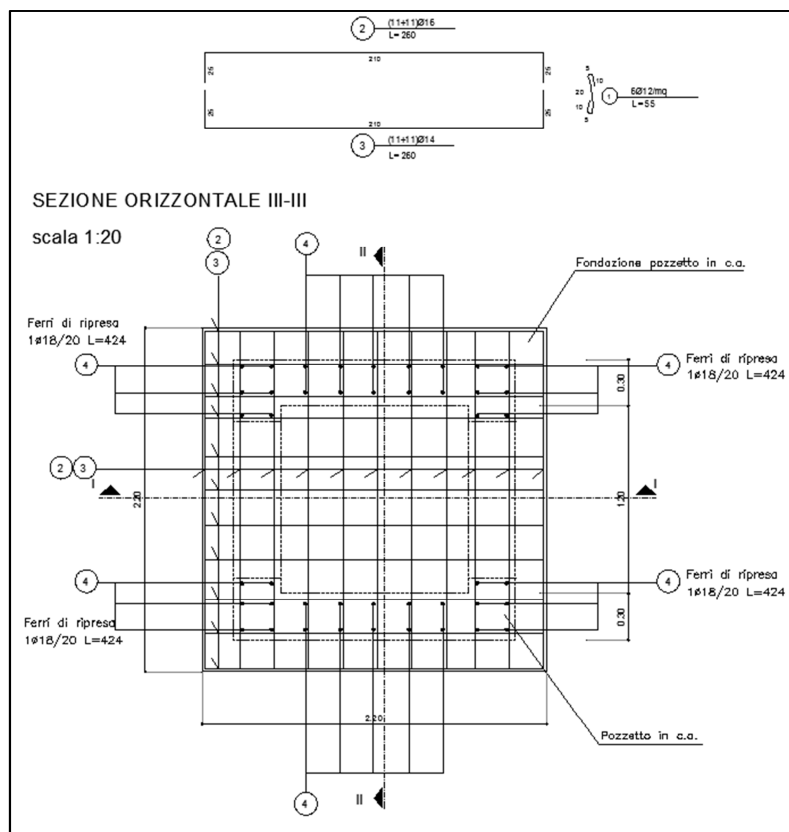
SCHEMA ARMATURA FONDAZIONE
